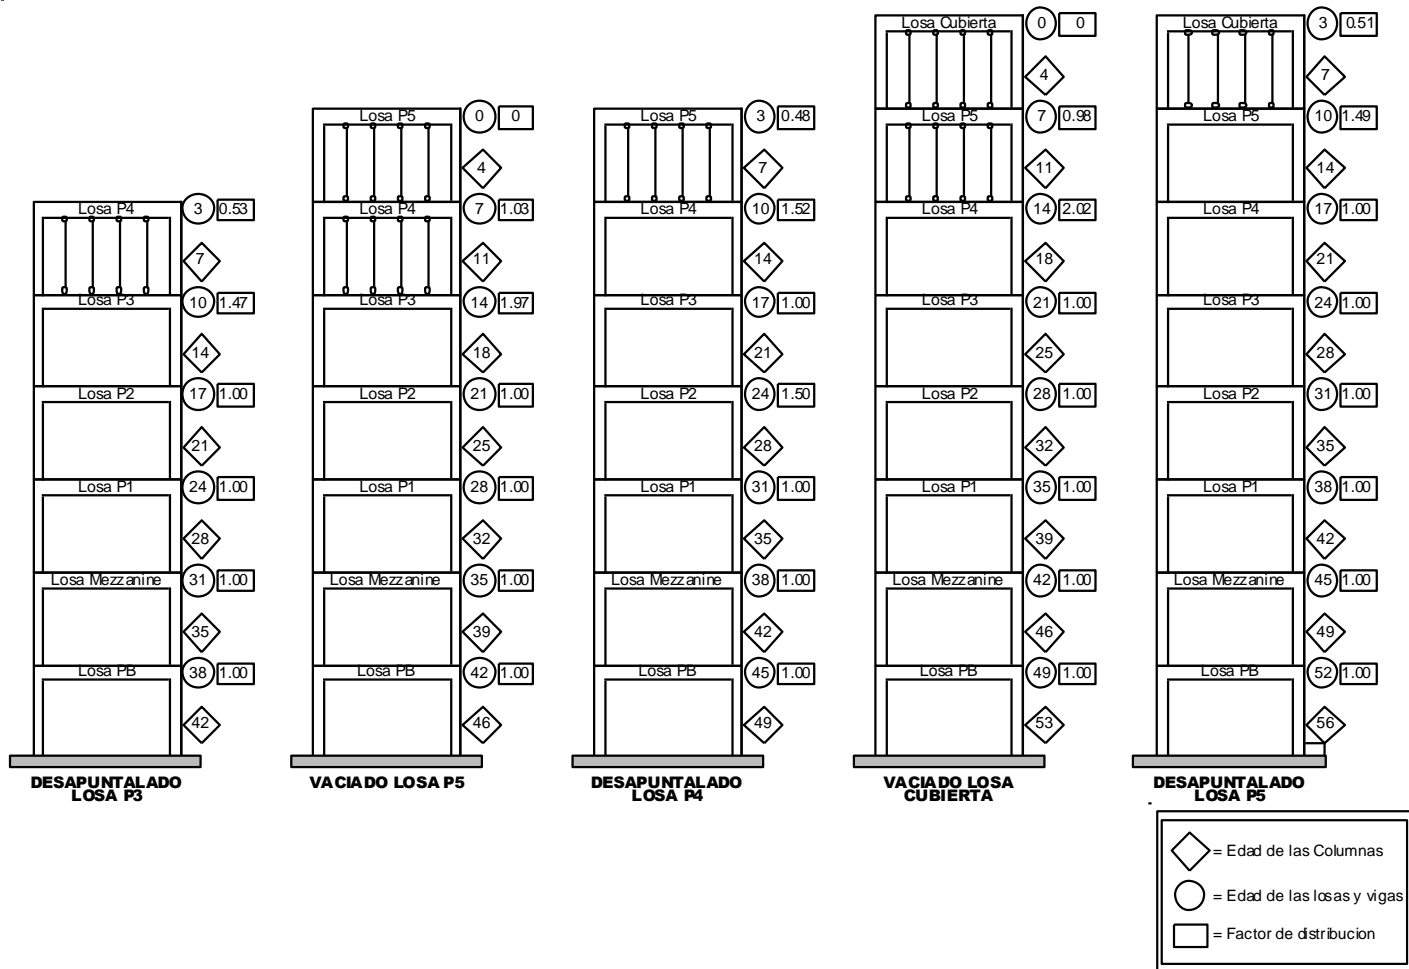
Etapas constructivas 11, 12, 13, 14 y 15 para un desapuntamiento de losa y viga a los 10 días.
